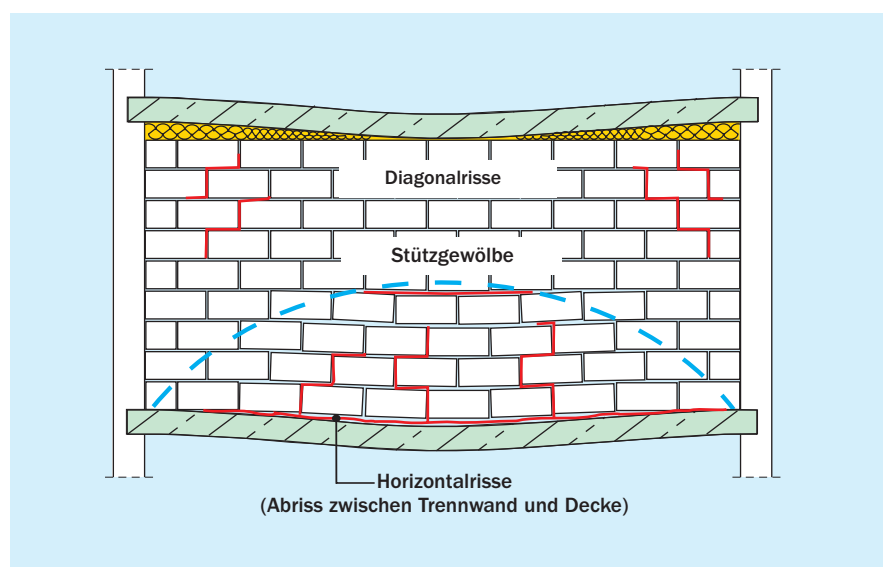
Riss in nicht tragender Trennwand infolge Durchbiegung der unteren Geschossdecke (Aufstandsfläche)
